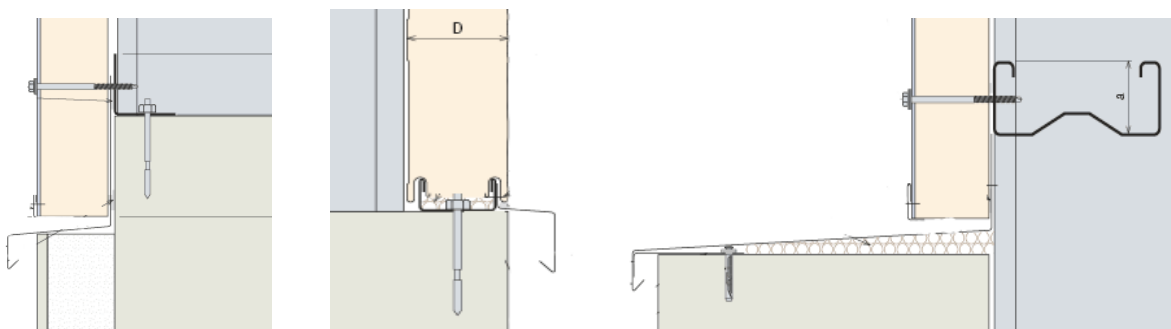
Remates de base da fachada. Adaptado de [84].
